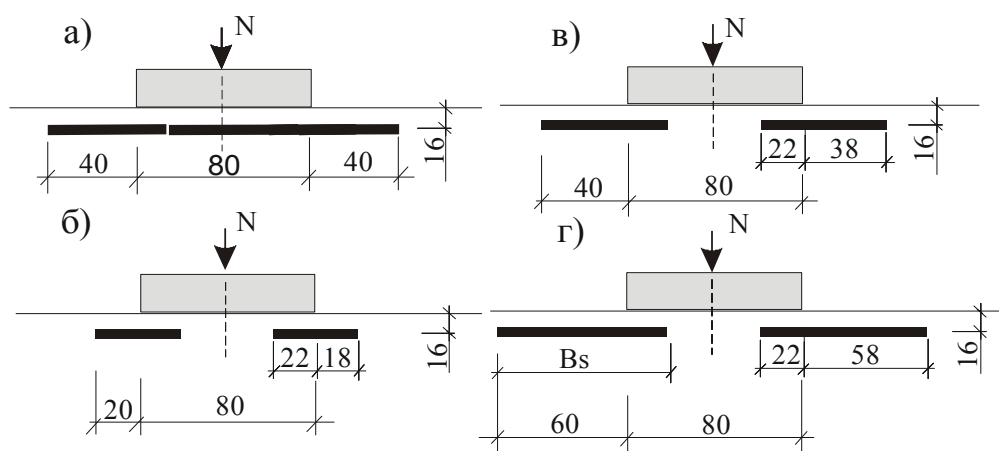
Схема нагружения модели жесткого фундамента и расположения армирующих прослоек
